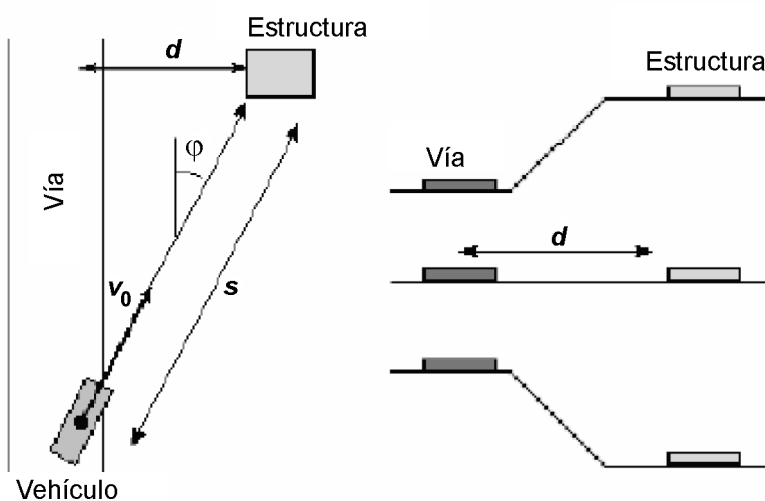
Croquis de situación para el impacto de vehículos (planta y sección transversal para una cuesta arriba, terreno plano y cuesta abajo)
